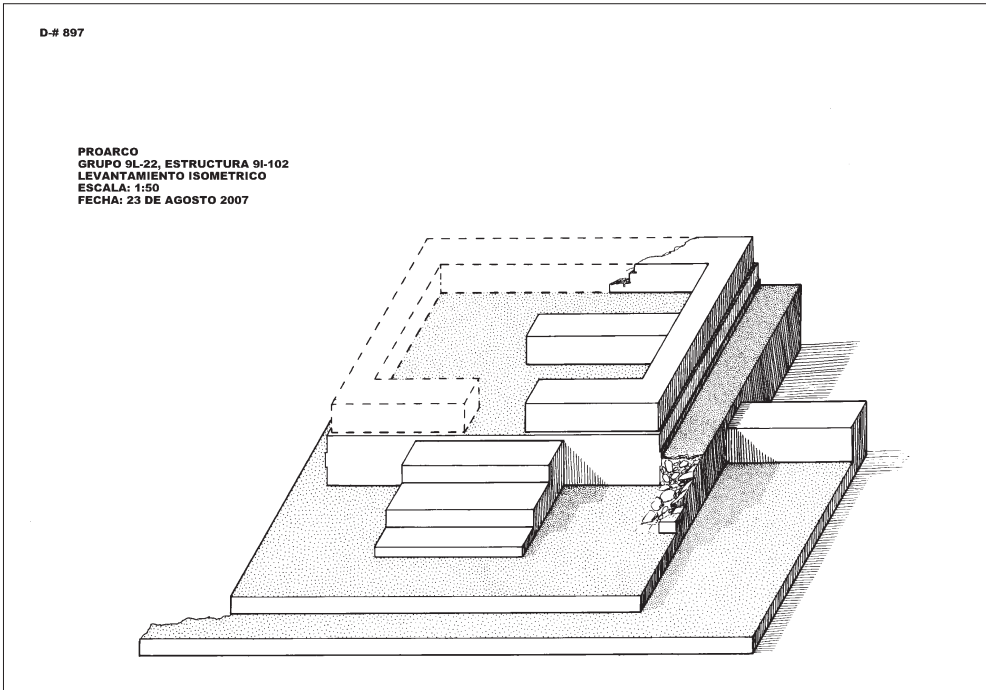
Reconstruccion hipotetica de la Estructura 9L-102
